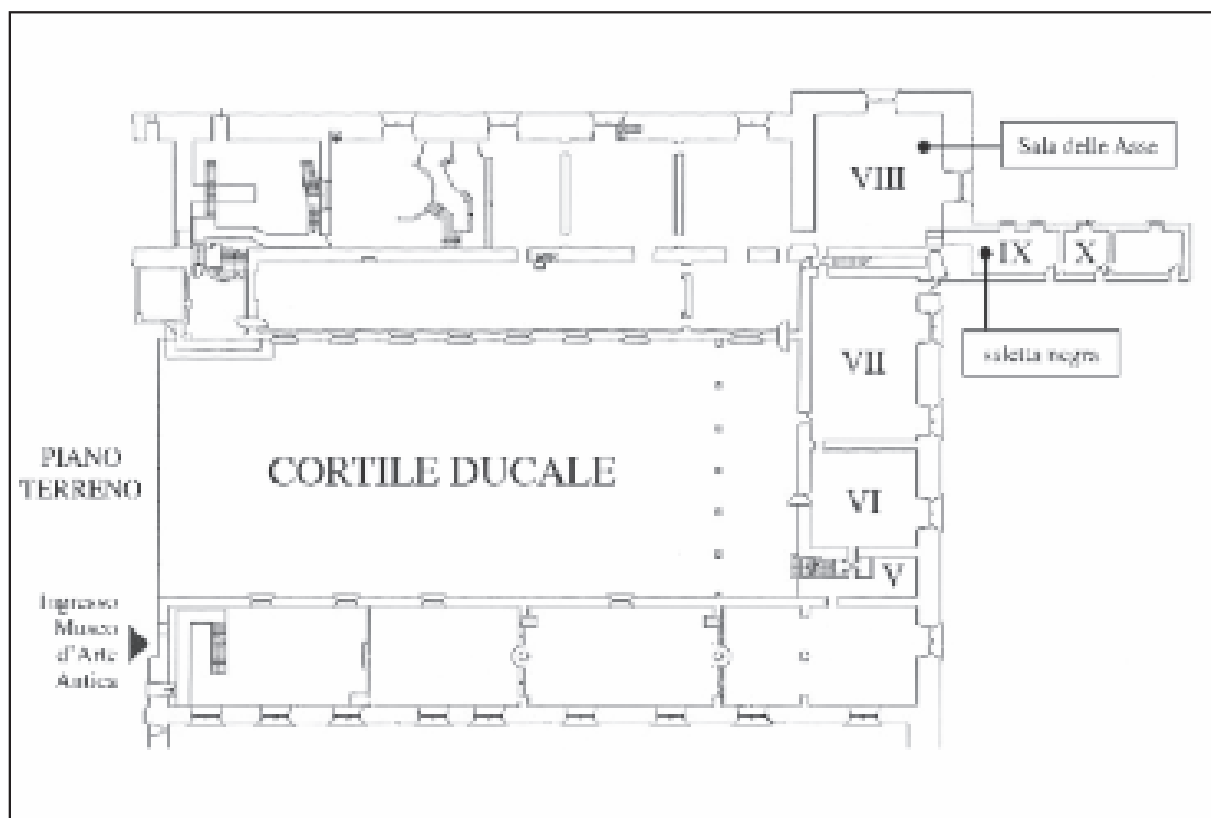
Milano, Castello Sforzesco, pianta della Corte Ducale, piano terreno; disposizione di alcune sale del Museo d'Arte Antica. Ricostruzione grafica di Luca Beretta
